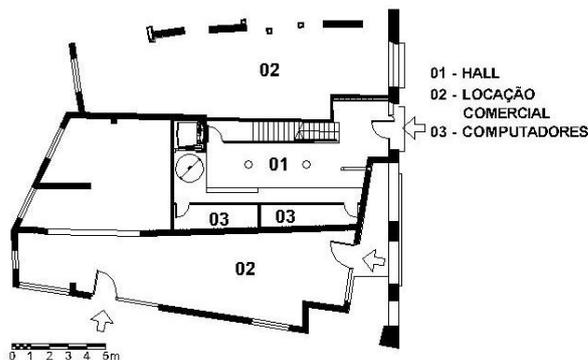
Planta Térrea da Habitação de Proteção Oficial Giralt el Pellisser
